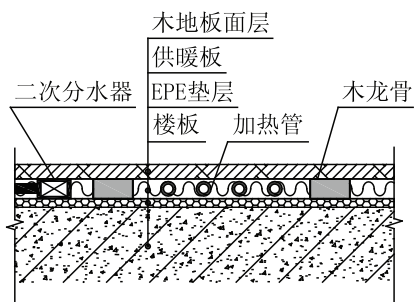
预制轻薄供暖板地面构造示意 (一)
